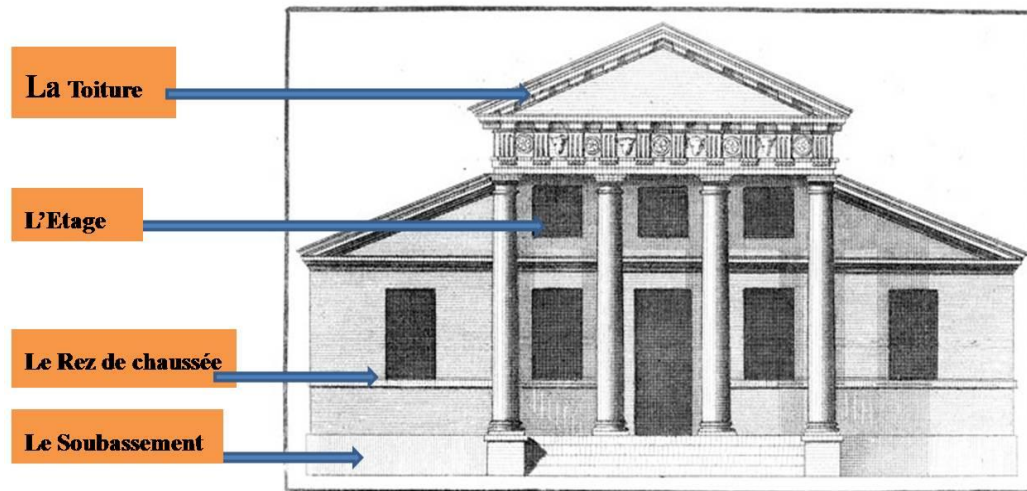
Les différentes composantes de la façade (Exemple de façade-A. Palladio, 1736)
